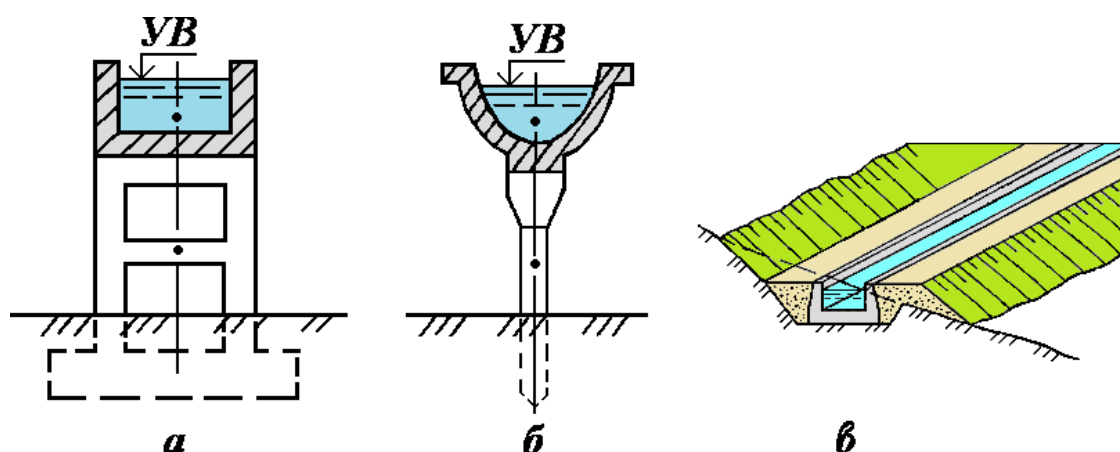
Поперечные сечения лотков: а — прямоугольный лоток на опоре; б — параболический железобетонный лоток; в — лоток на косогоре
